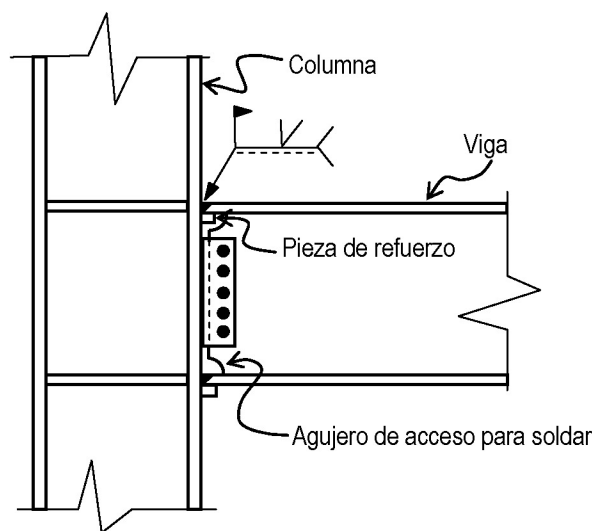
Banderín indicando soldadura «a pie de obra»
